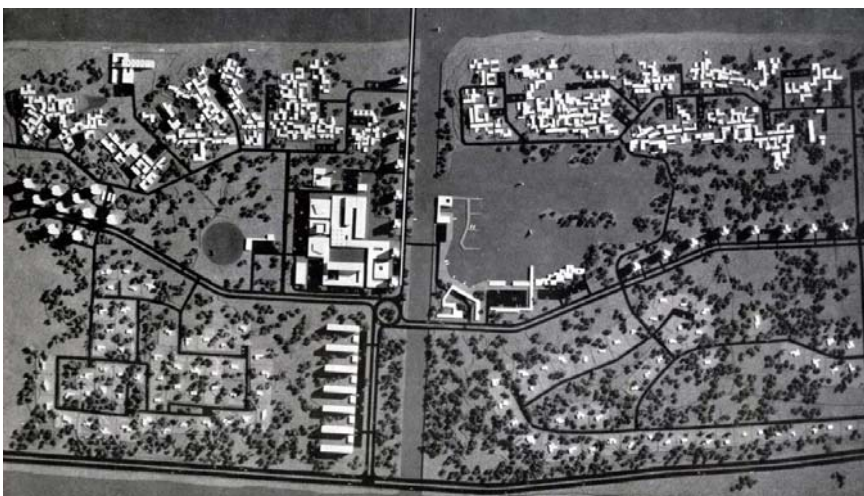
Tramo central de la maqueta de la propuesta para El Saler de J. Cano Lasso en 1962-64
